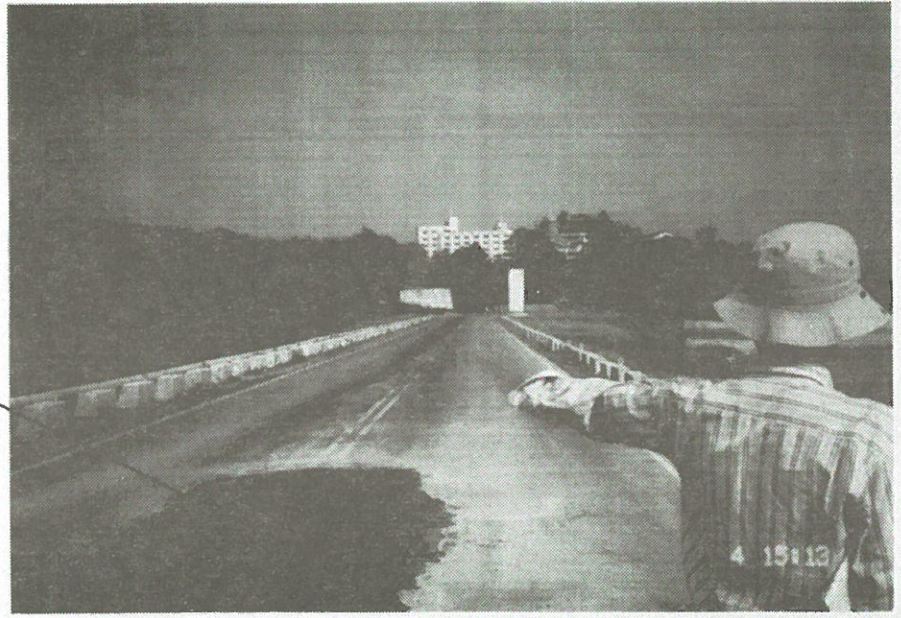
水社ダム堤頂の亀裂の補修状況
